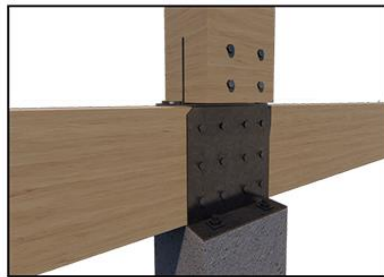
Detalle estructural de anclajes metálicos. Elaboración propia.
